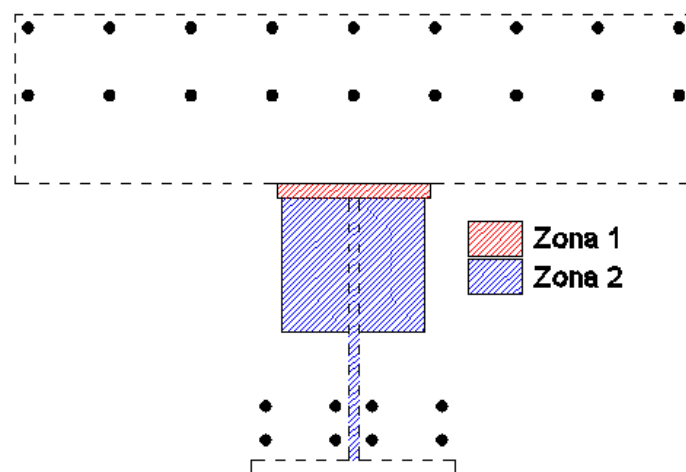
Localizações do eixo neutro para secções com perfil metálico envolvido em betão (M-).
